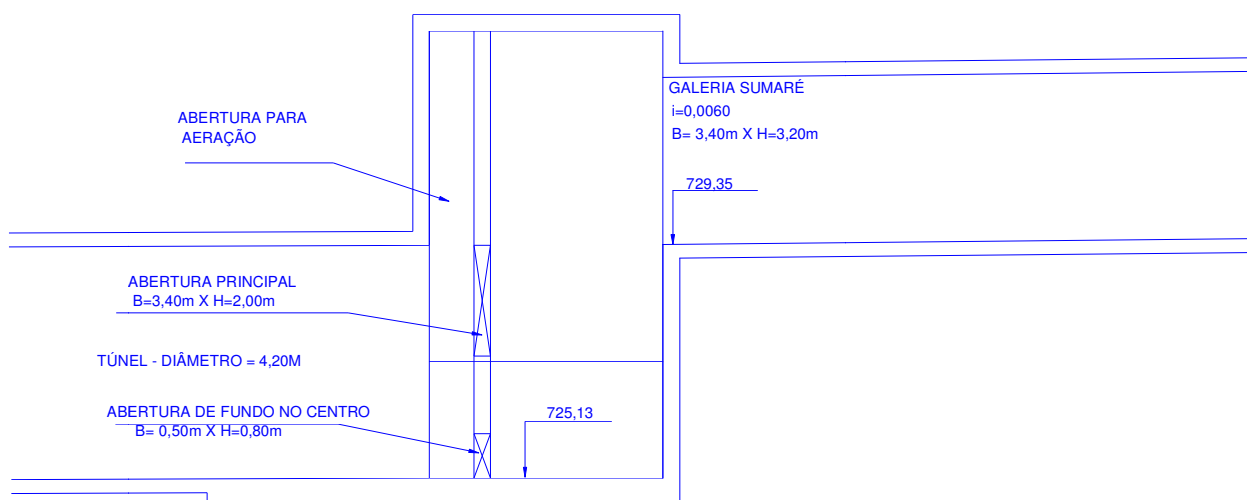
Croqui esquemático da caixa 4 com a disposição do muro de separação e do conduto de aeração.
